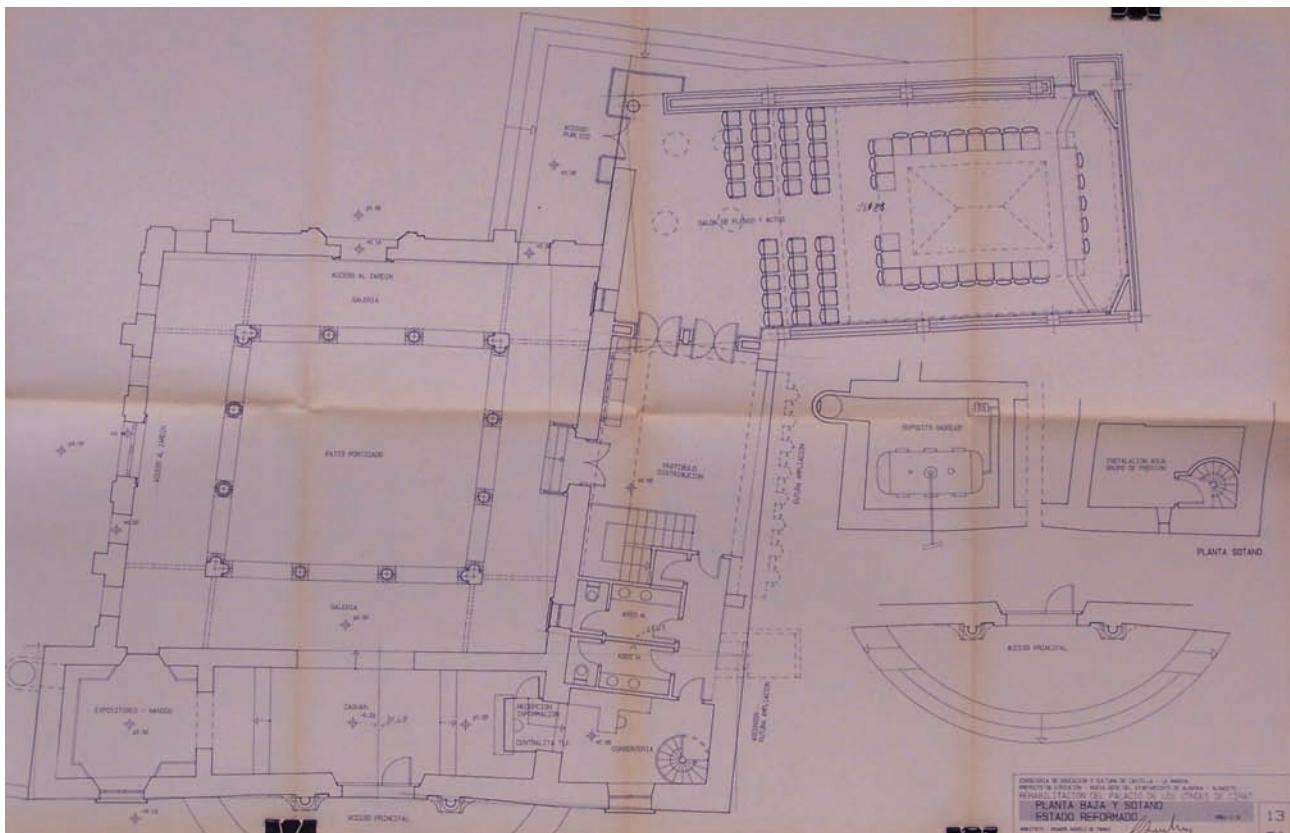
Planta Casa Grande. Ayuntamiento nuevo. AMA legajo 1616.
